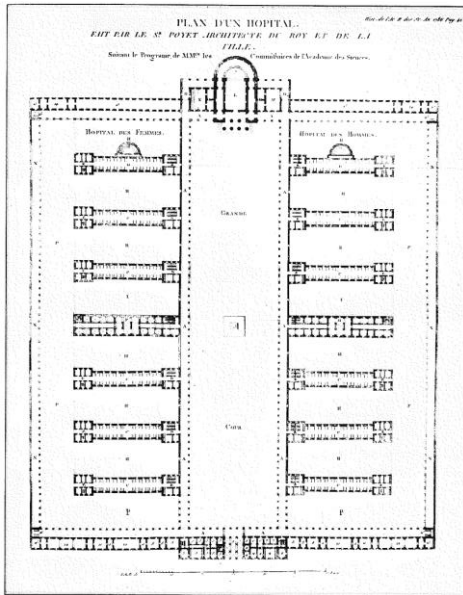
Planta para la Academia de las Ciencias de Poyet.
